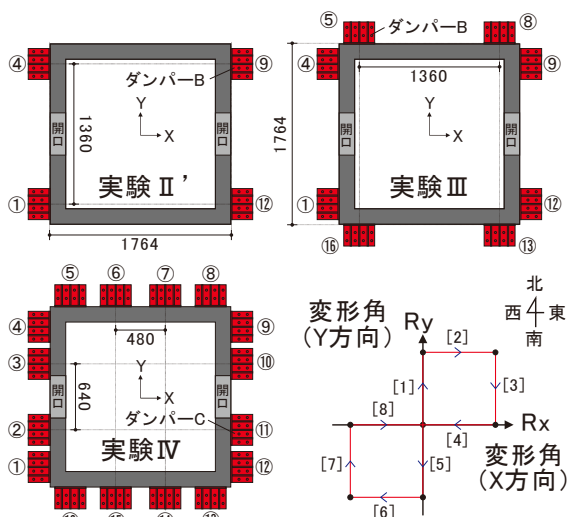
ダンパー配置図及び载荷経路 (単位: mm)
